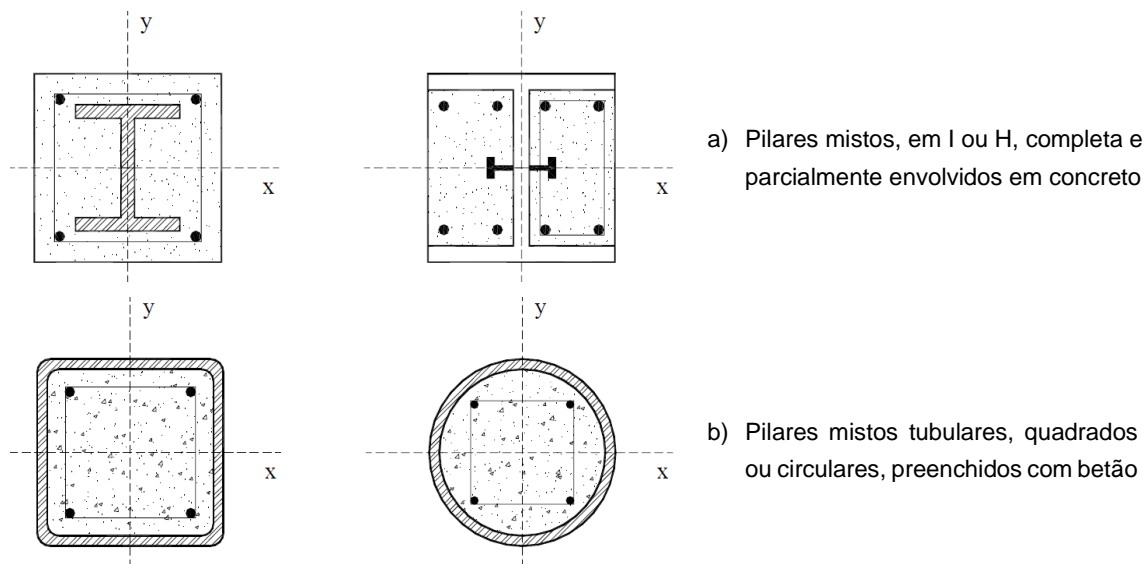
Exemplos de secções transversais de pilares mistos [8].
